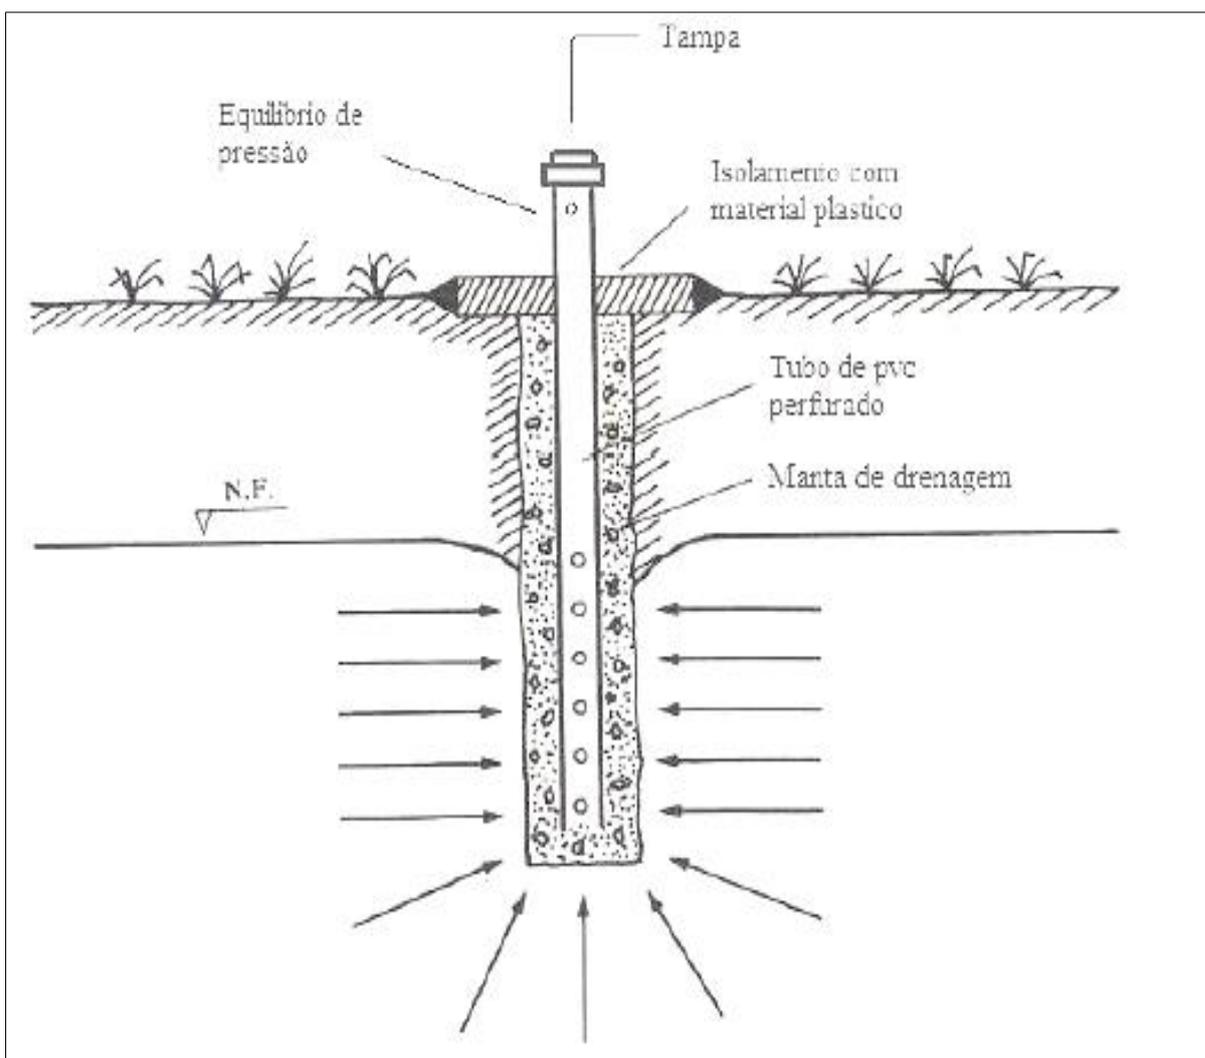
Esquema do modelo de poço de observação instalado. Fonte: (CRUCIANI, 1987).
